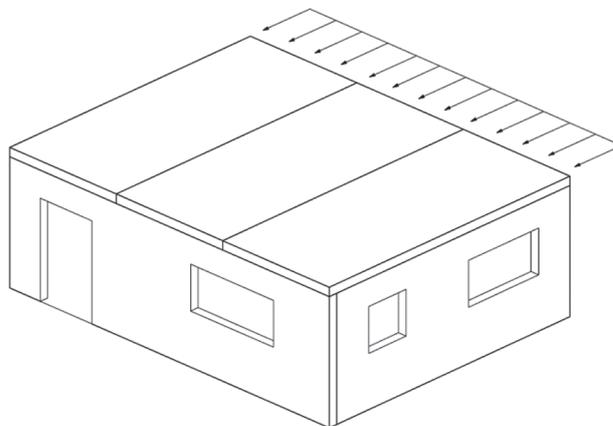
Diaphragme de plancher : Effort de traction induit sur les joints entre panneaux
